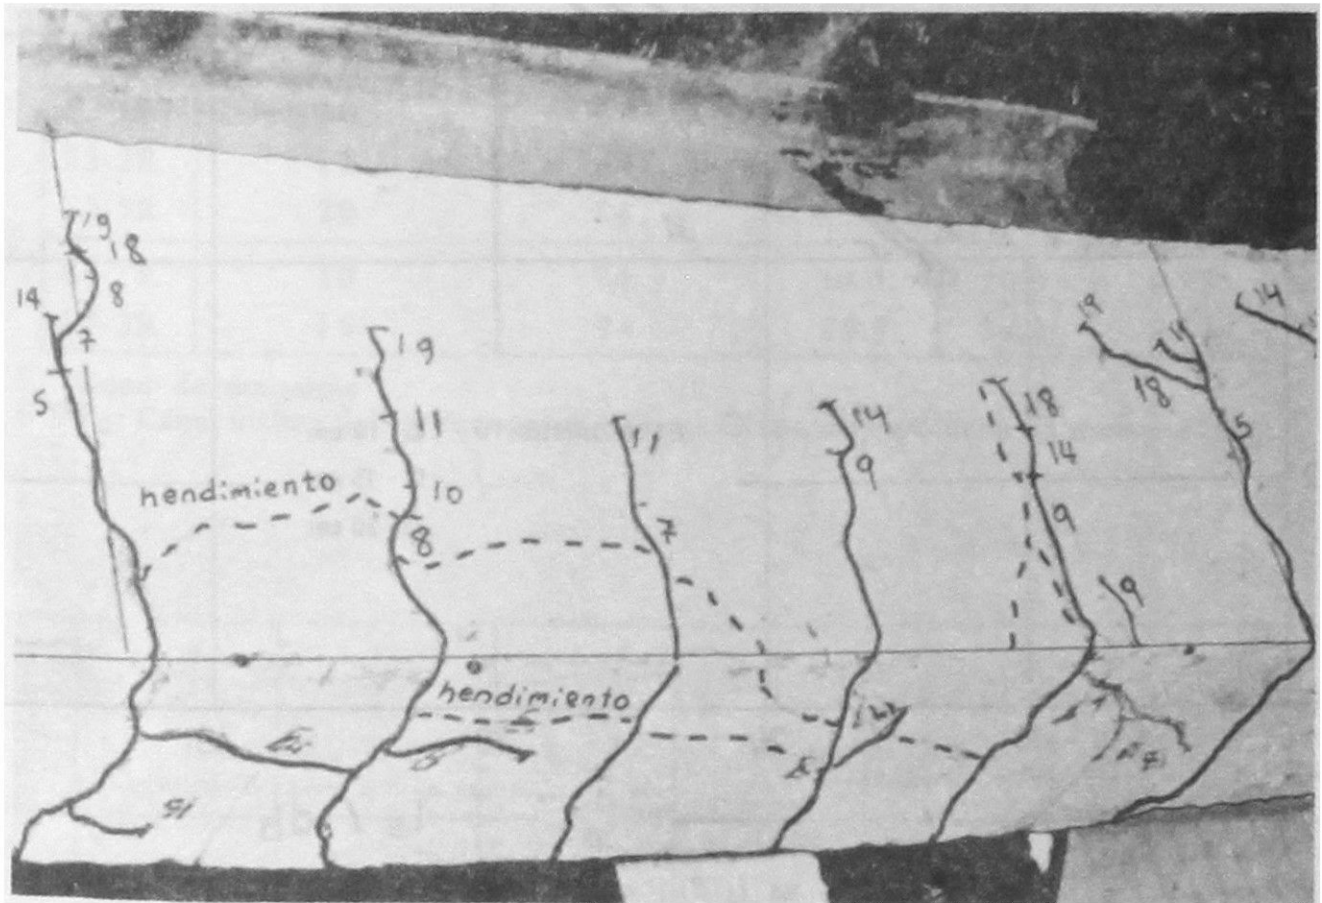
Estado de agrietamiento final. Viga s4-1:  $l_s = 74 \text{ cm}$
